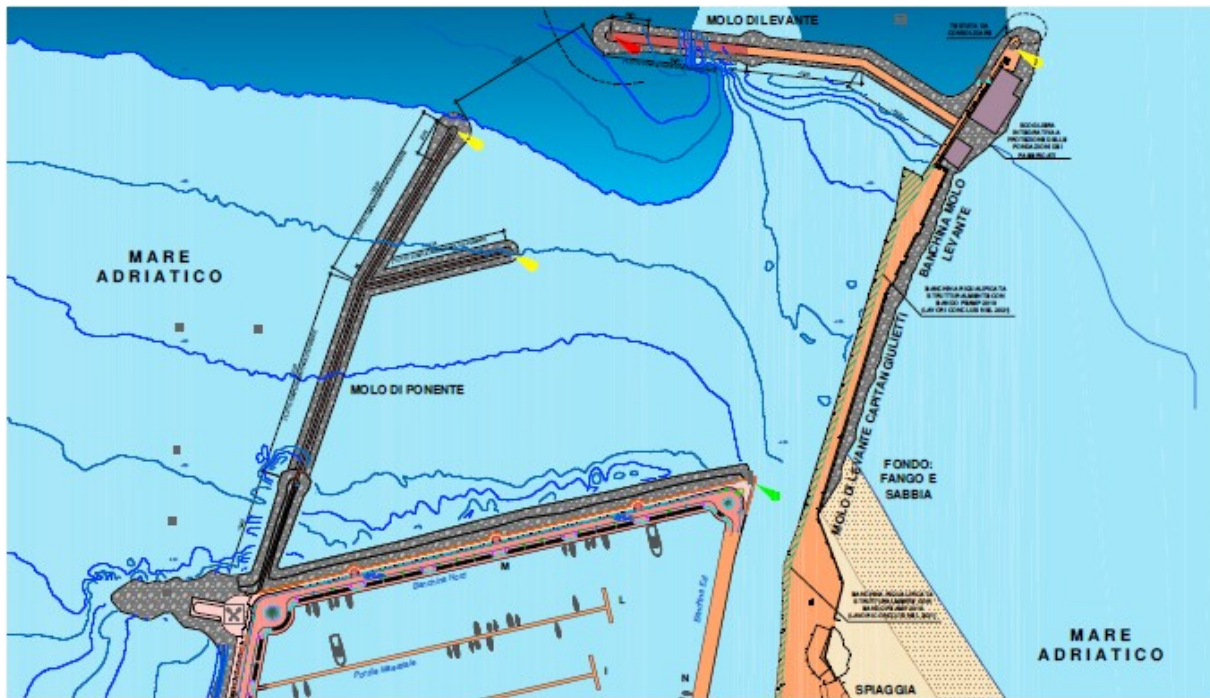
Planimetria generale del nuovo avamposto in progetto.
